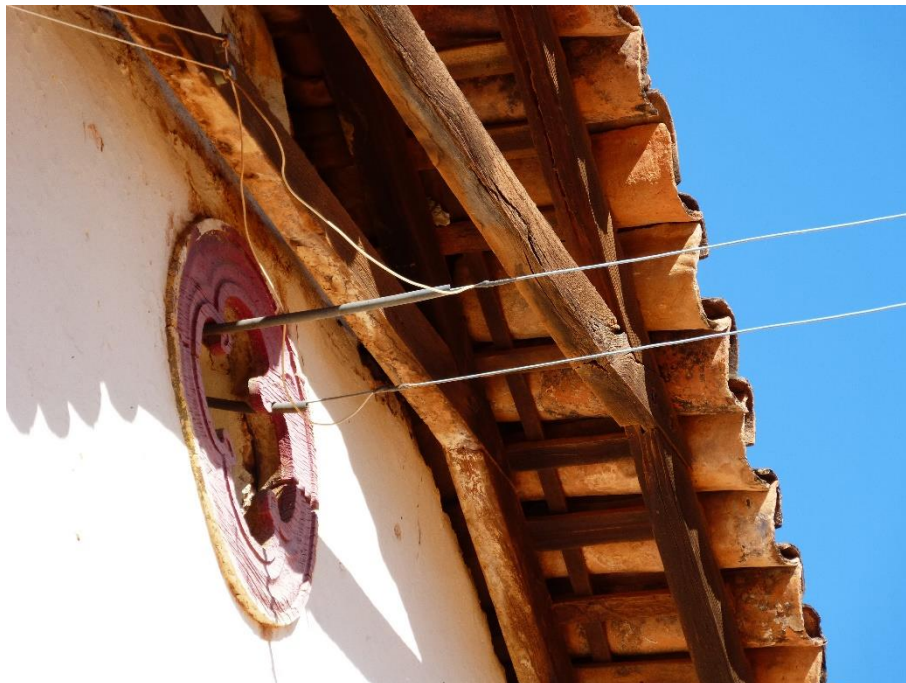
Detalhe do estado de conservação – Fiação elétrica passando pelo óculo da fachada principal.
